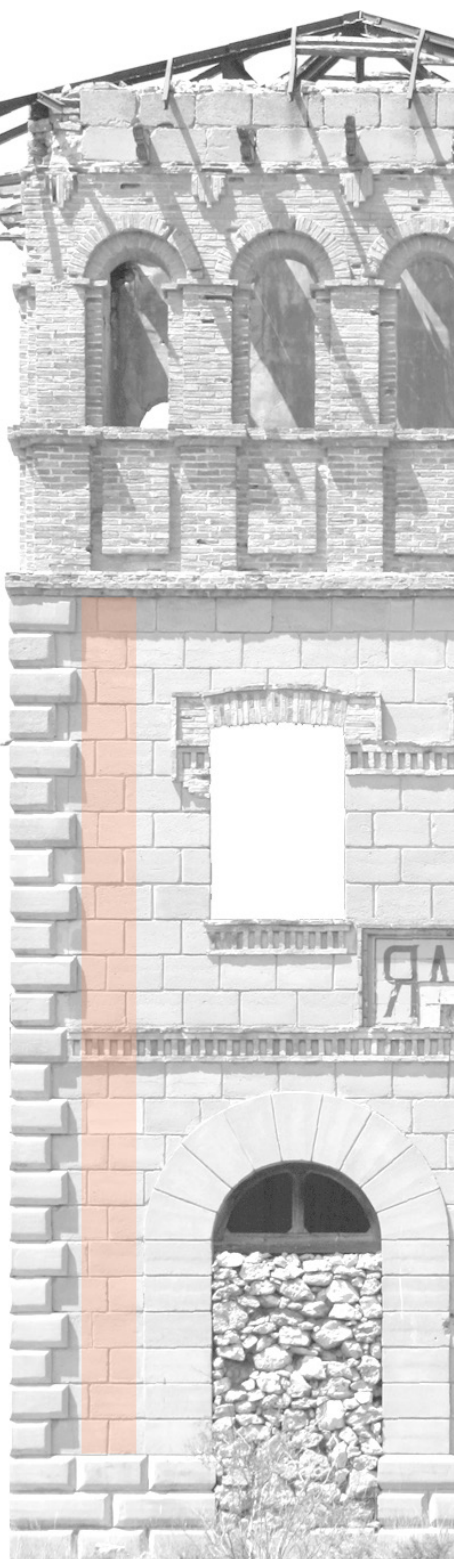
Vista de la fachada testera con el cuerpo de la torre del edificio de viajeros de Palomar de Arroyos donde se puede comprobar la disposición de piezas enteras en la altura del paño del muro..
